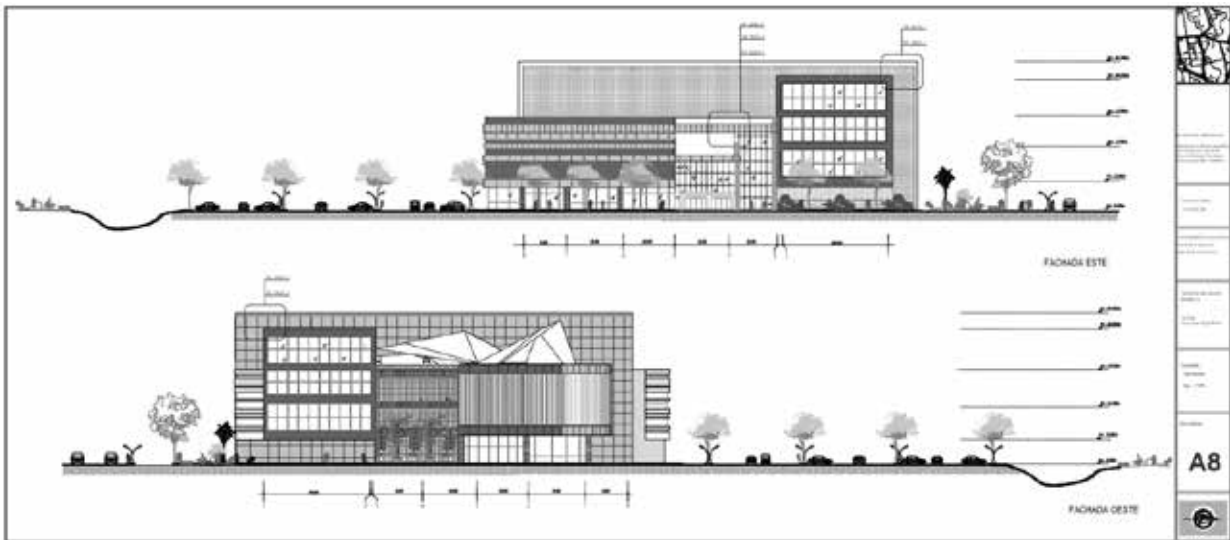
Fachada Este y Oeste A-8. La Autora (2015)
